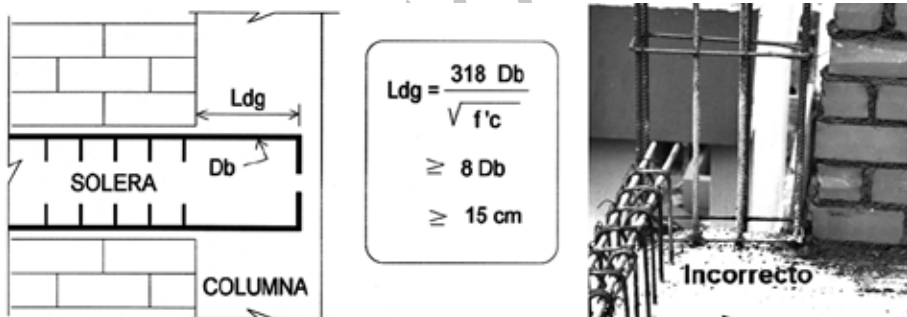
Anclaje del refuerzo de vigas (Ldg). A la izquierda el refuerzo está recortado.
